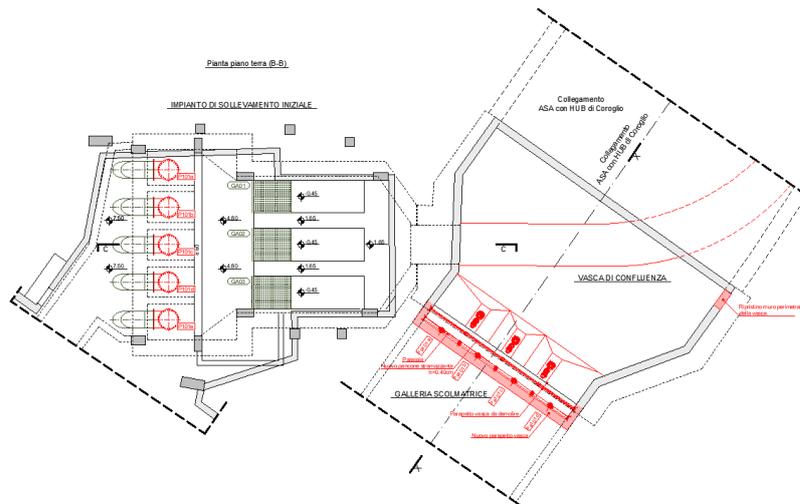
Sollevamento iniziale - Stato di progetto - Pianta piano terra
